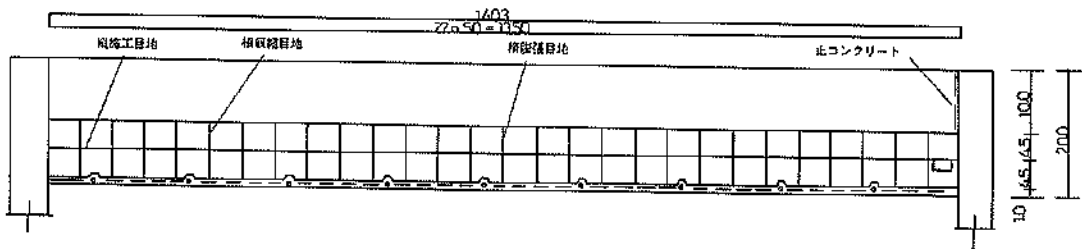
平面図, 標準断面図 (十勝港, ③物揚場(-4.0m))
